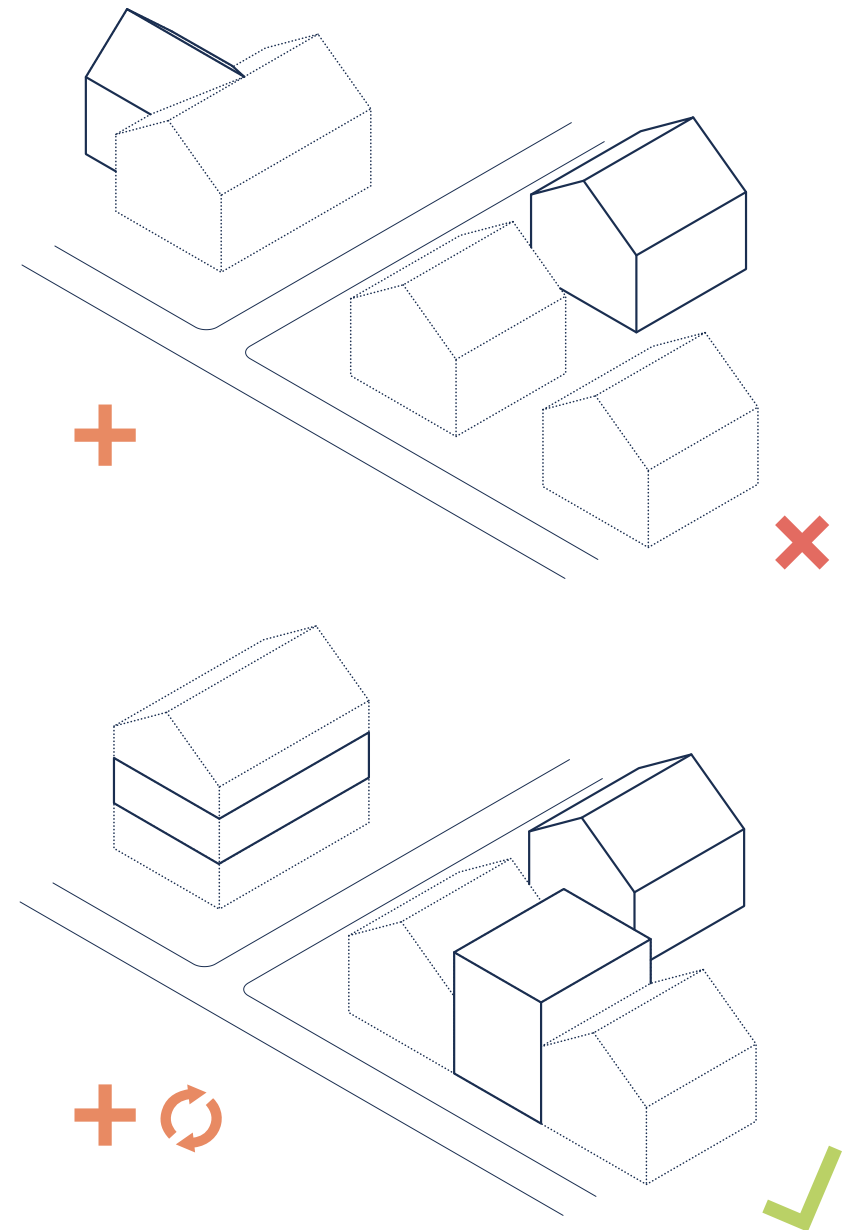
Angewandte und zukünftige Möglichkeiten der Nachverdichtung im „Gartenviertel“
